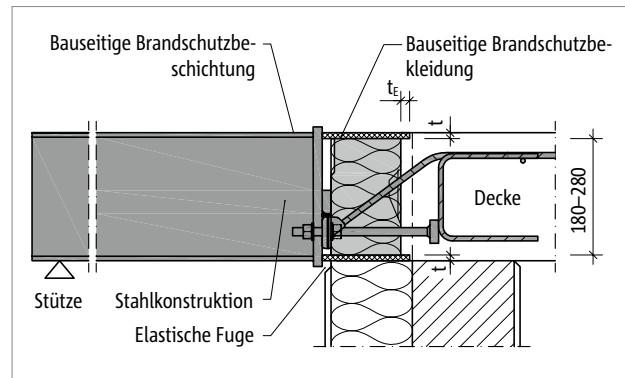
Schöck Isokorb® XT Typ SQ: Bauseitige Brandschutzbekleidung für den Isokorb®, brandschutzbeschichtete Stahlkonstruktion; Schnitt
